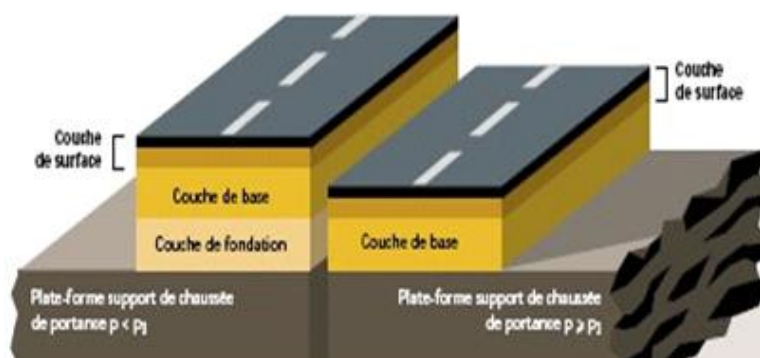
Structure type d'une chaussée semi-rigide.
